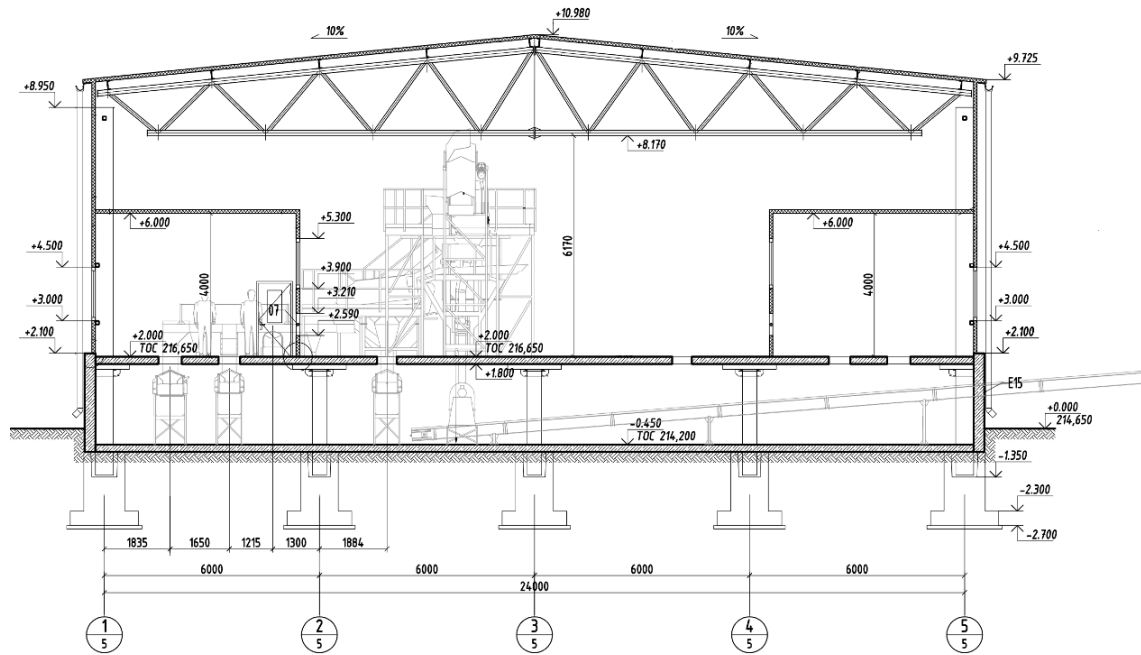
Поперечний розріз будівлі з позначками основних рівнів
